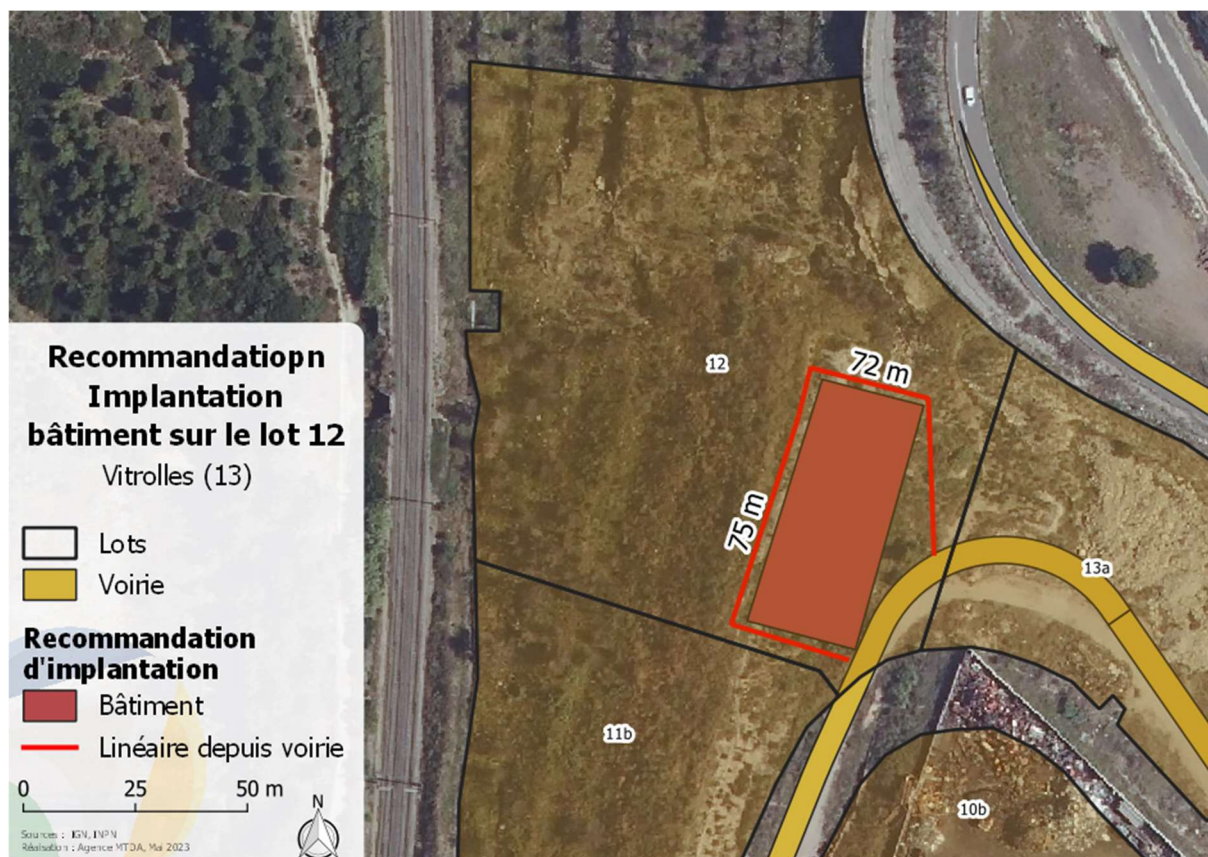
recommandation pour l'implantation du bâtiment sur le lot 12
